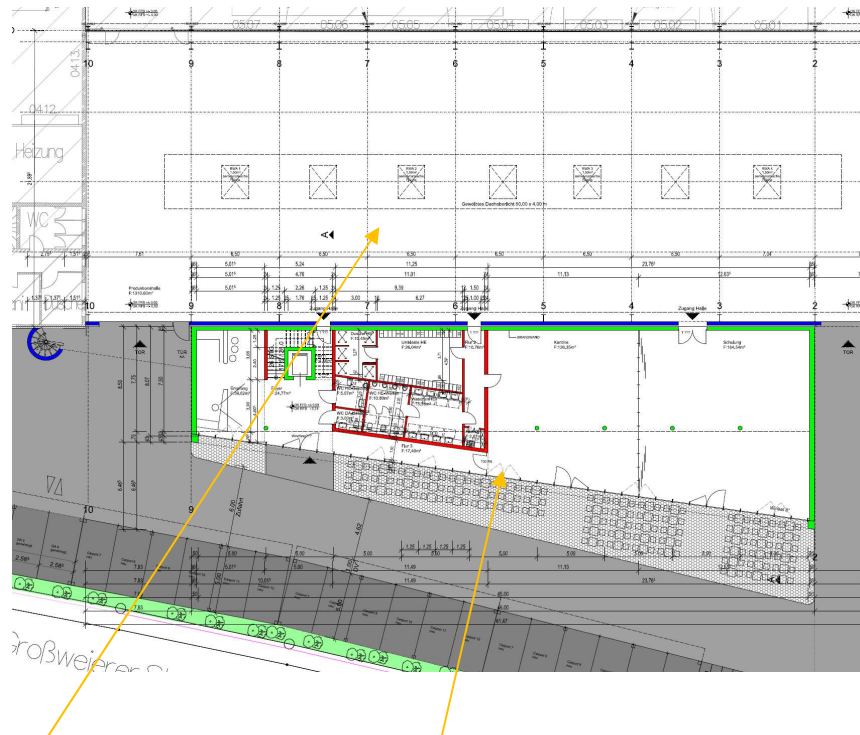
Erweiterung der Halle und Neubau Bürogebäude
